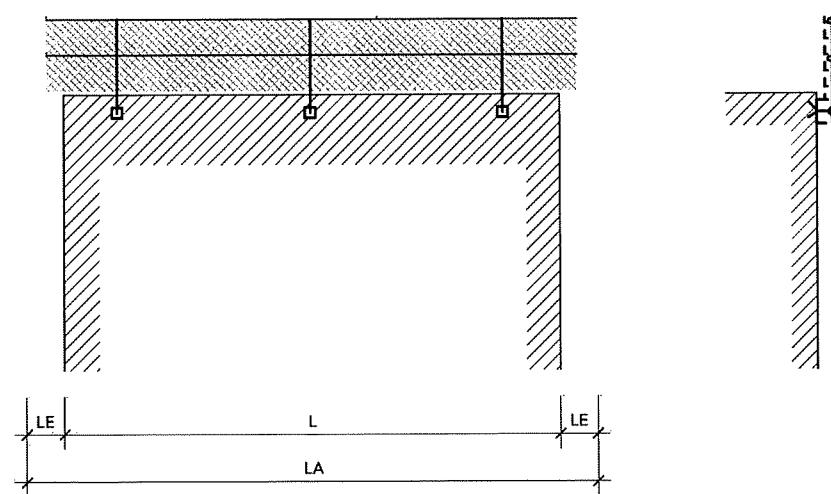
Absturzsicherung für Flachdach an Fassade befestigt
